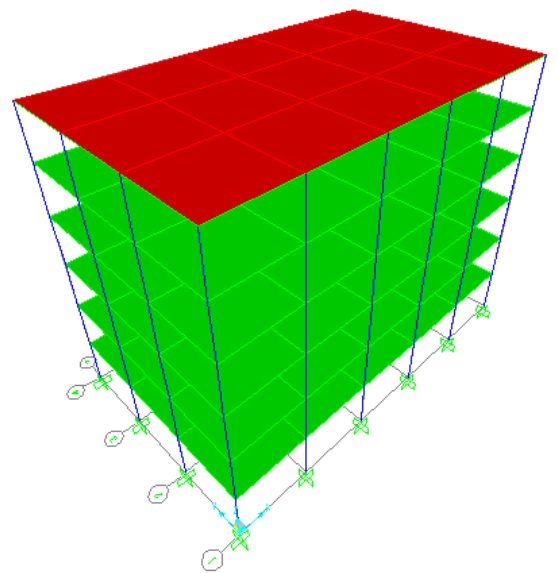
Denah bangunan Sistem Ganda (Dual System)
